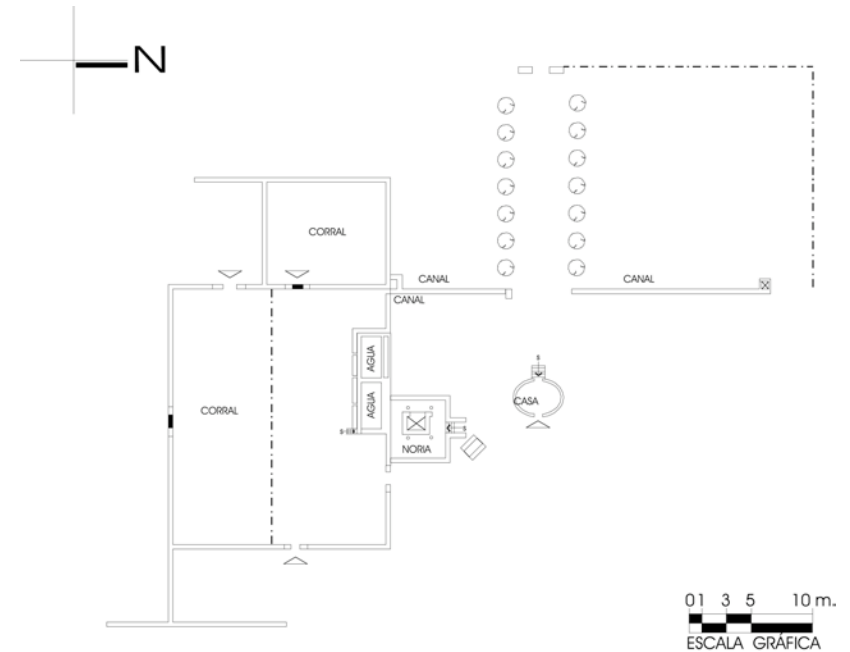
Planta arquitectónica de la hacienda agrícola de Becal en Campeche.
